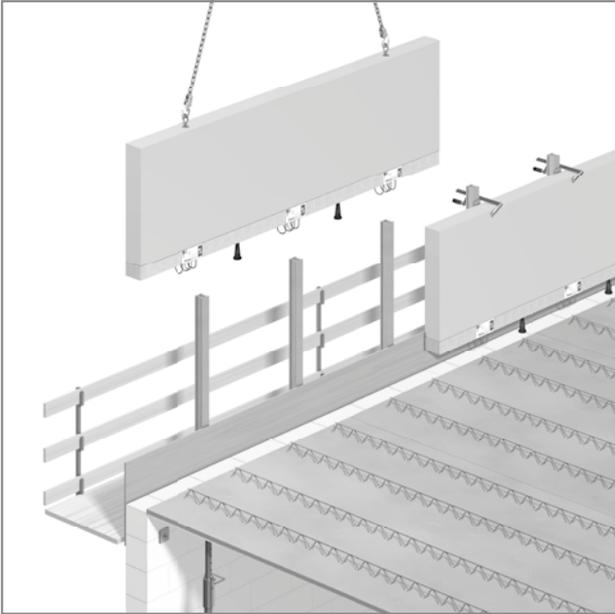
Schöck Isokorb® XT type A with Combar® FT erection support: Hoisting of the prefabricated attic
